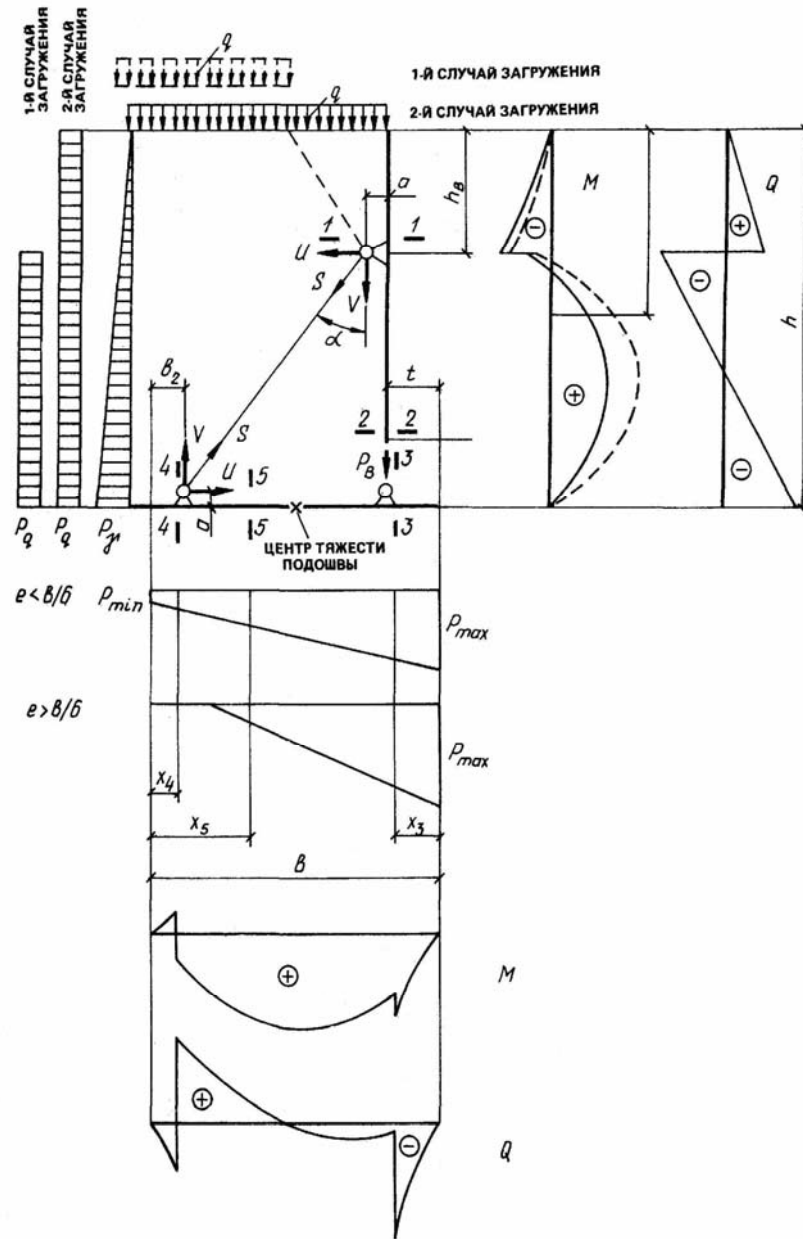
К расчету подпорной стены с анкерными тягами
